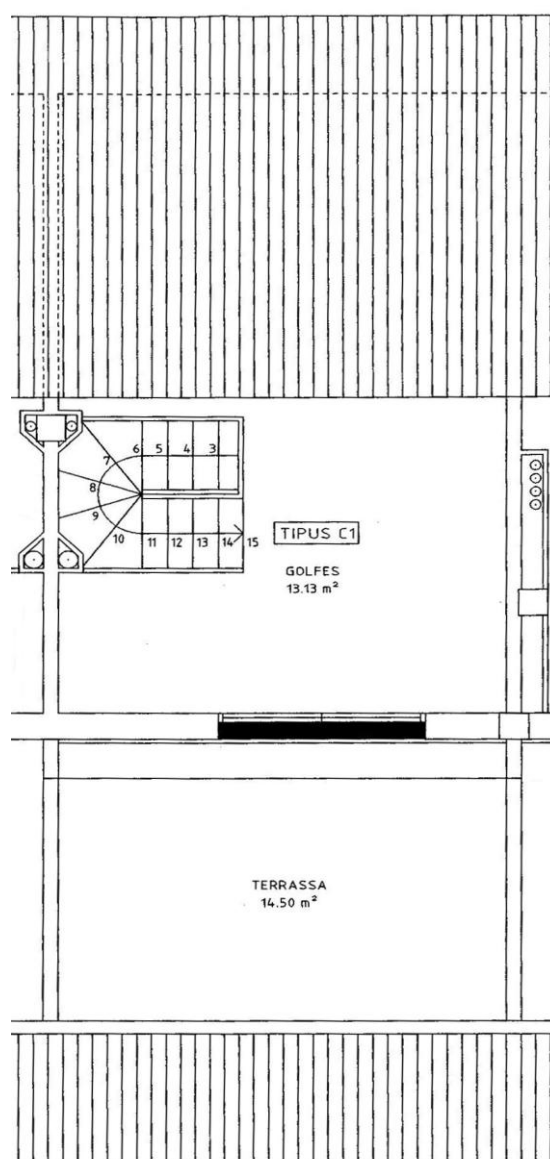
Plano de la segunda planta (memoria de calidades de la vivienda).
